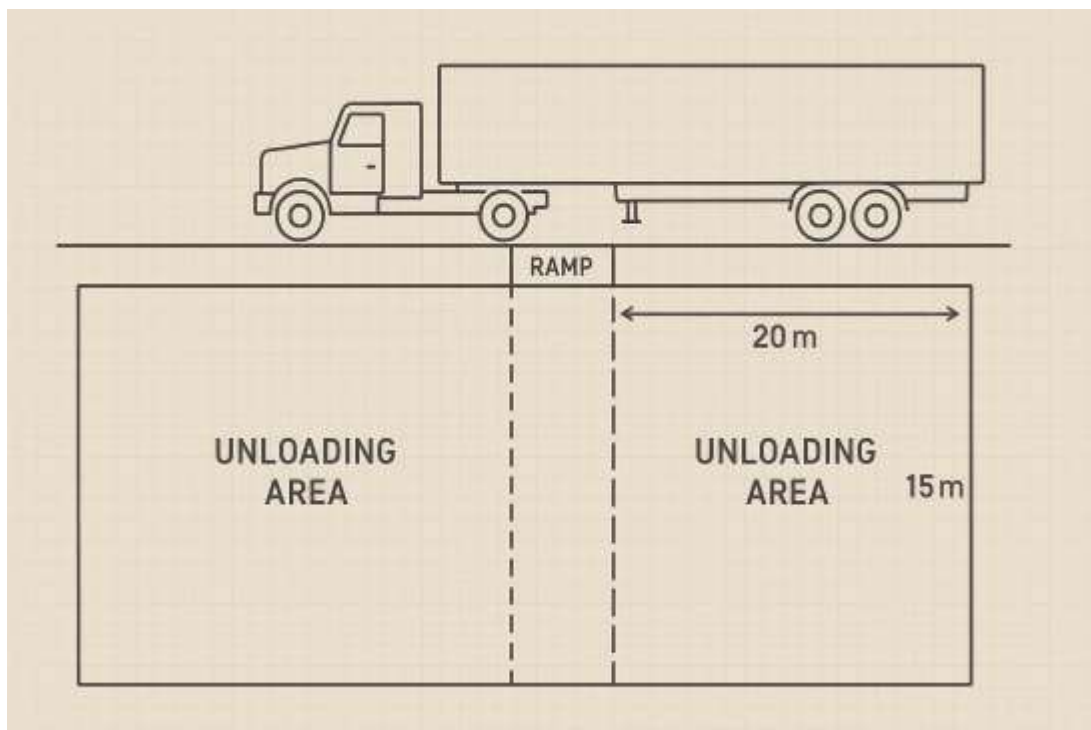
Plano Área de Descarga Nota: Elaboración Propia
